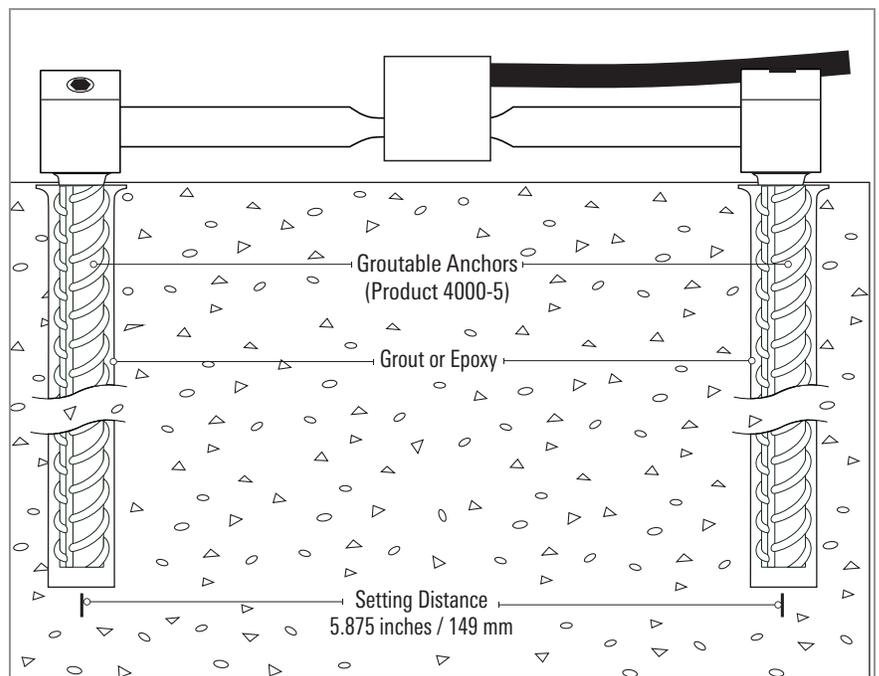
Instalación en concreto utilizando anclajes de fijación
